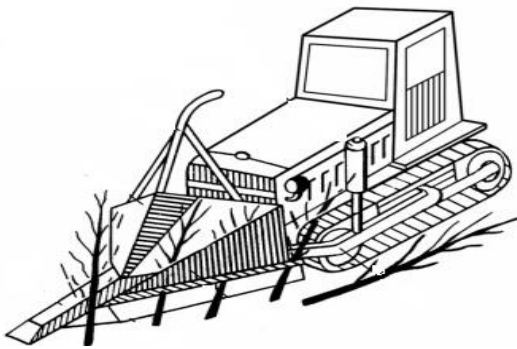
Загальний вигляд причіпного кущоріза
